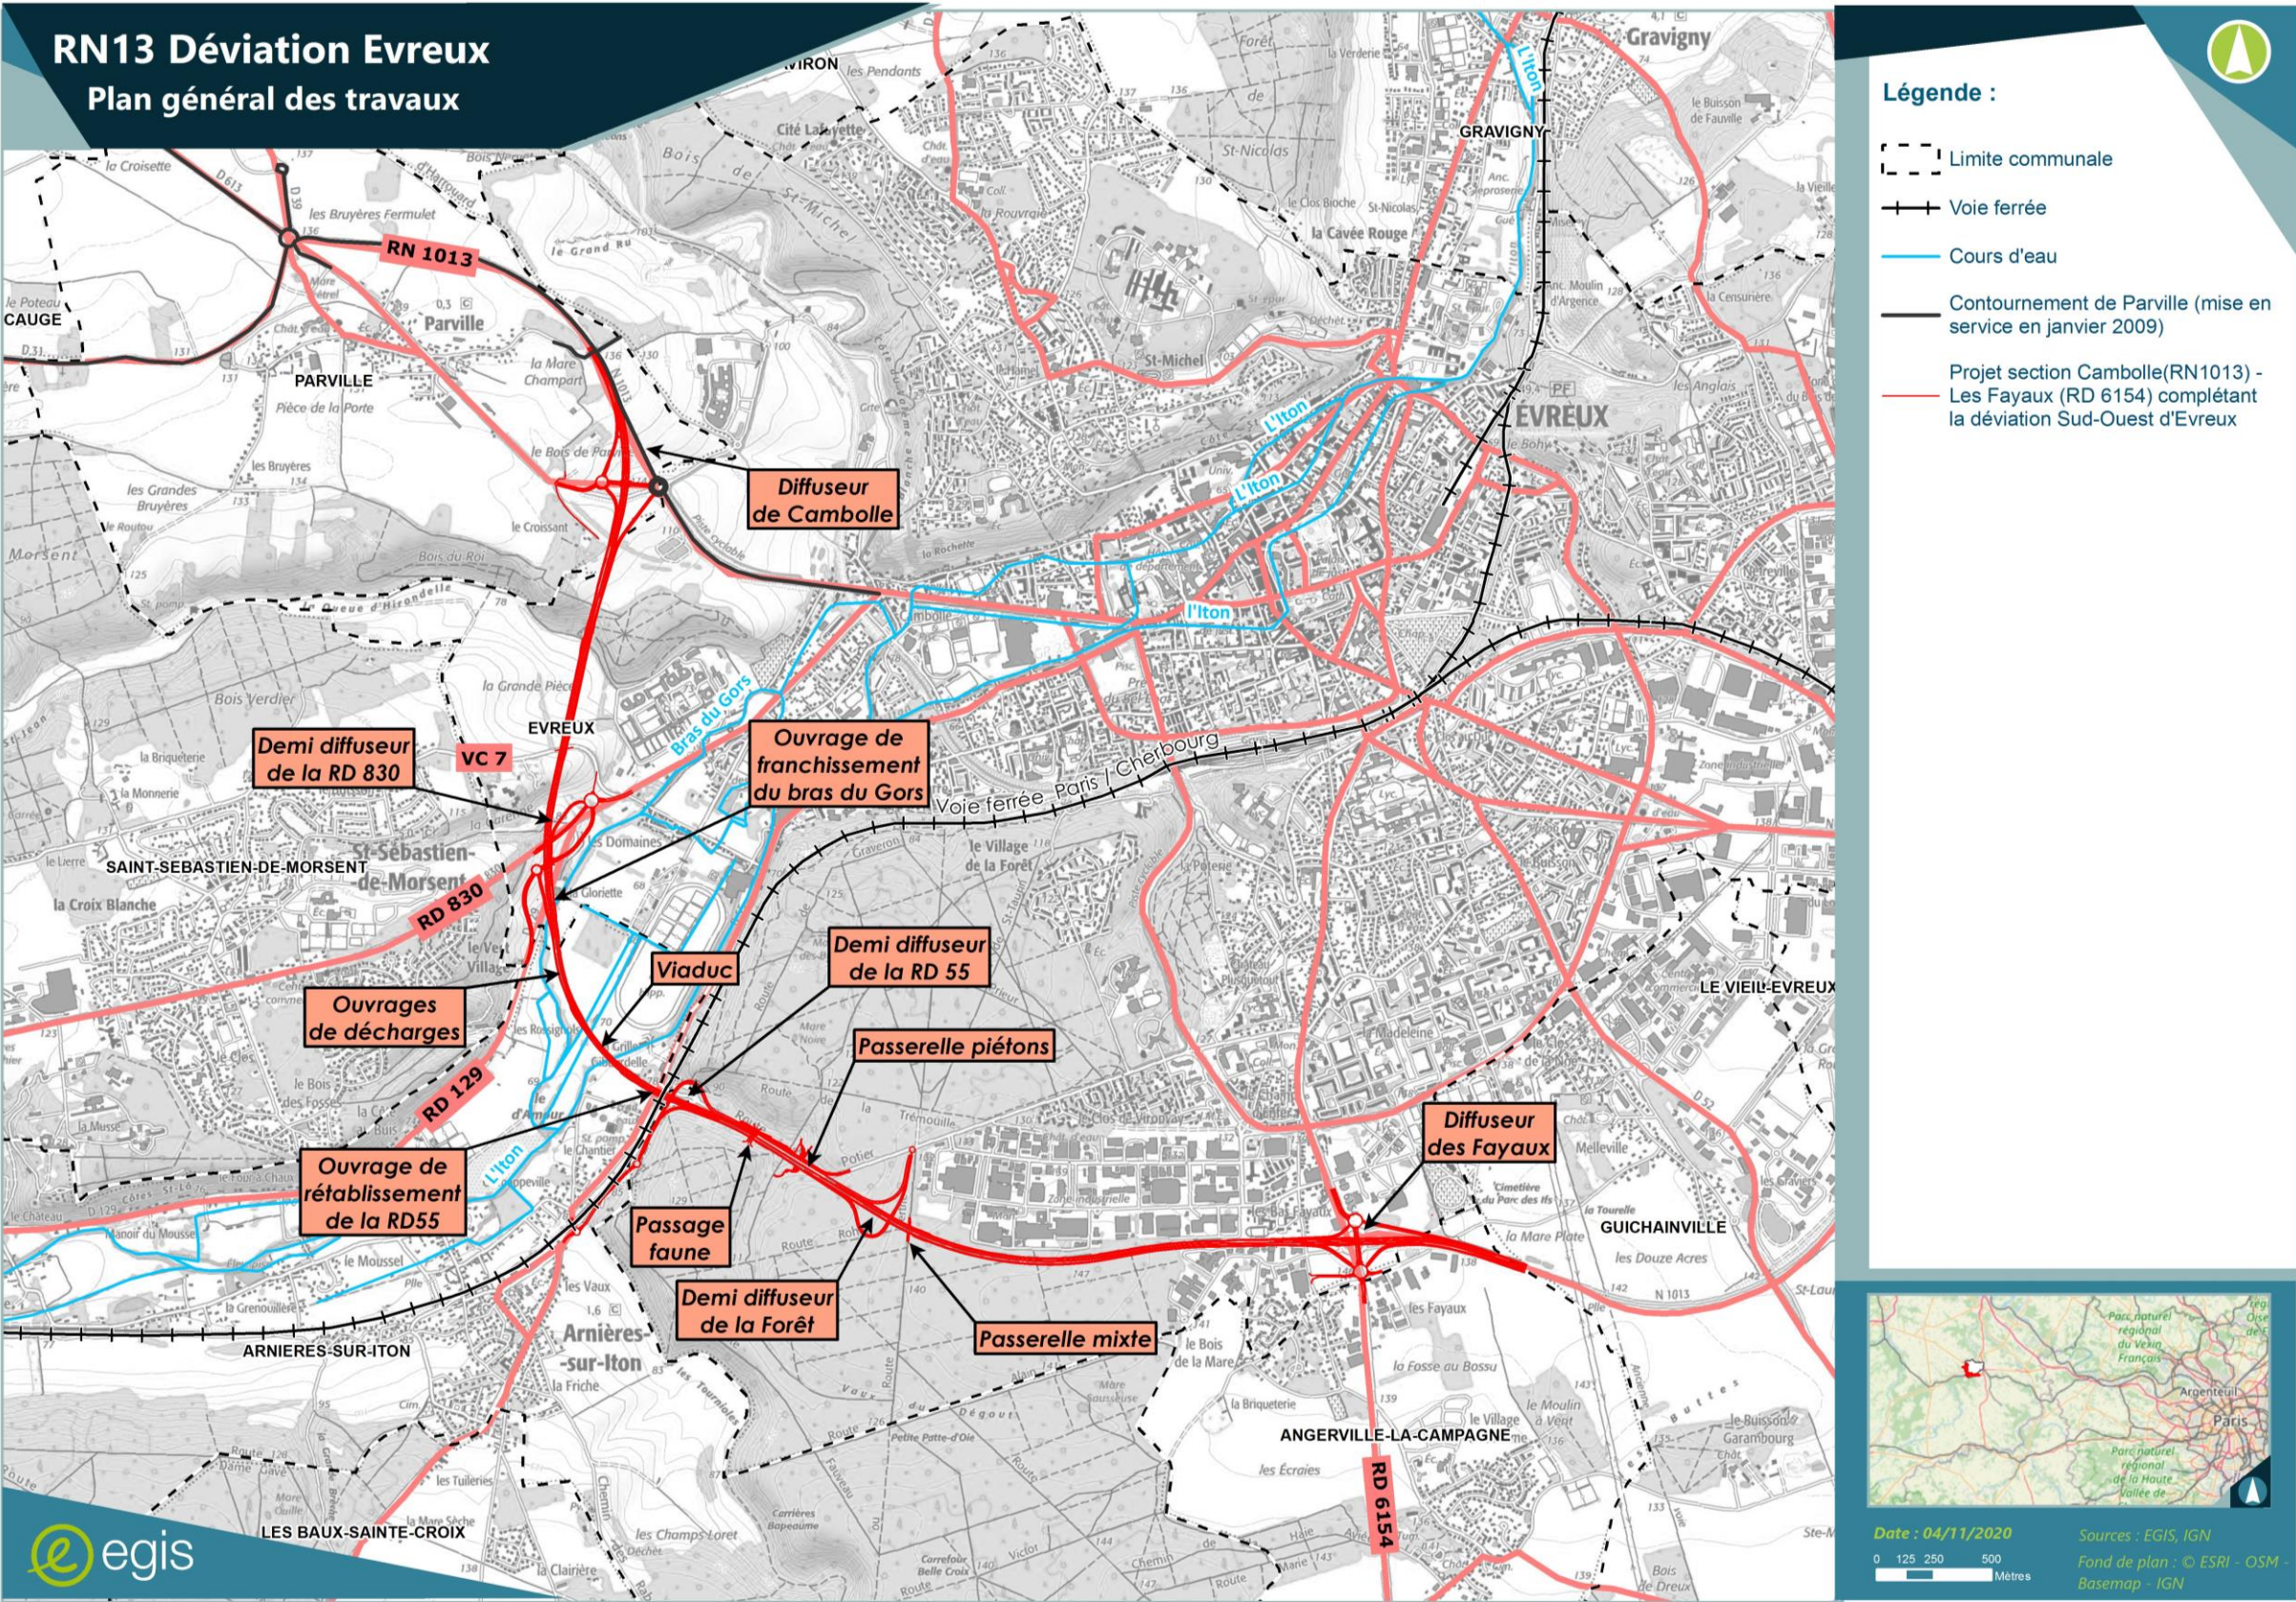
Plan général des travaux de la déviation sud-ouest d'Évreux, section Cambolle (RN1013) - les Fayaux (RD6154)
